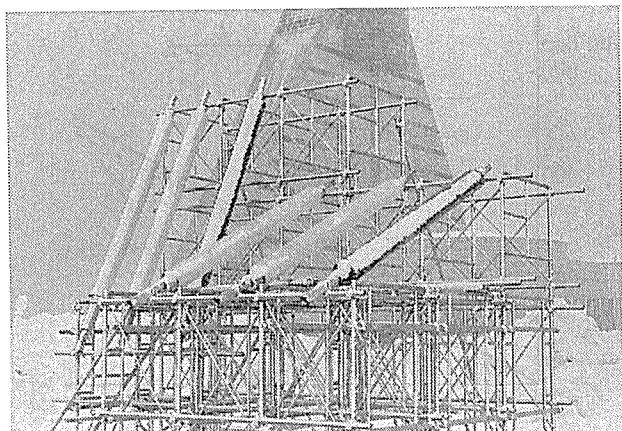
外套管の着雪暴露試験 (FRP 管, PE 管)
